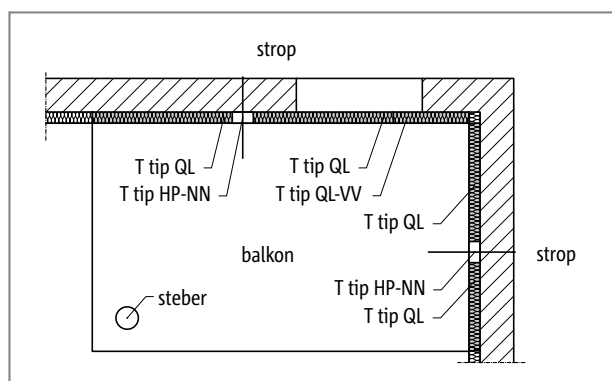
Schöck Isokorb® T tip HP: balkon z ležajem na stebrih
